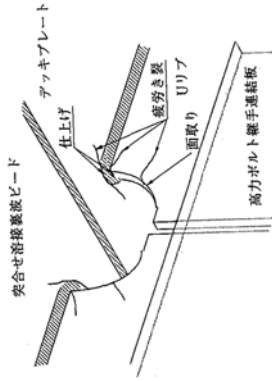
スカラップまわし溶接部の疲労き裂
